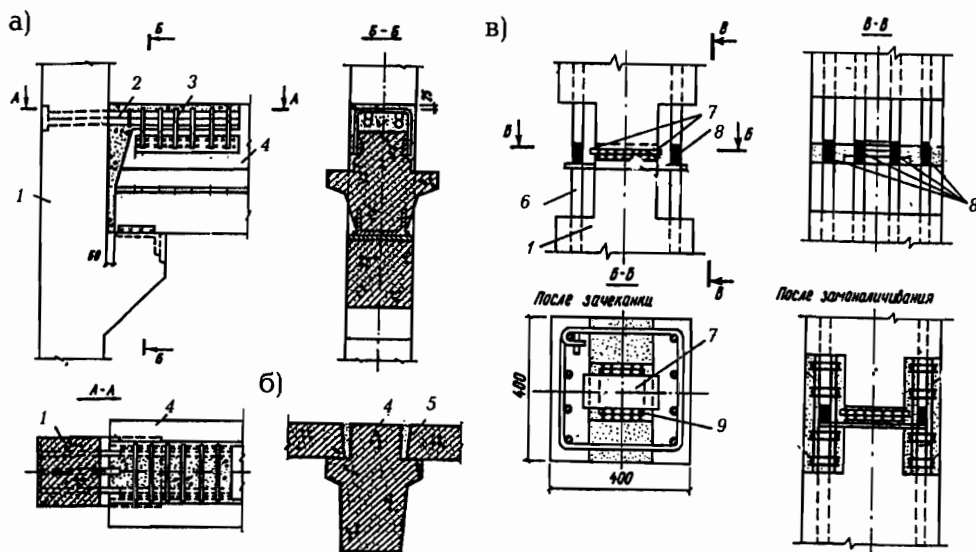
Узлы сопряжения элементов рамного каркаса: а - стык ригеля с колонной, б - сопряжения плит перекрытий с ригелем; в - стык колонн; 1 - колонны; 2 - спаренные выпуски арматуры; 3 - хомуты; 4 - ригель; 5 - плита перекрытия; 6 - выпуски арматуры; 7 - центрирующая прокладка; 8 - ванная сварка выпусков арматуры; 9 - места сварки центрирующей прокладки с закладными деталями колонн
